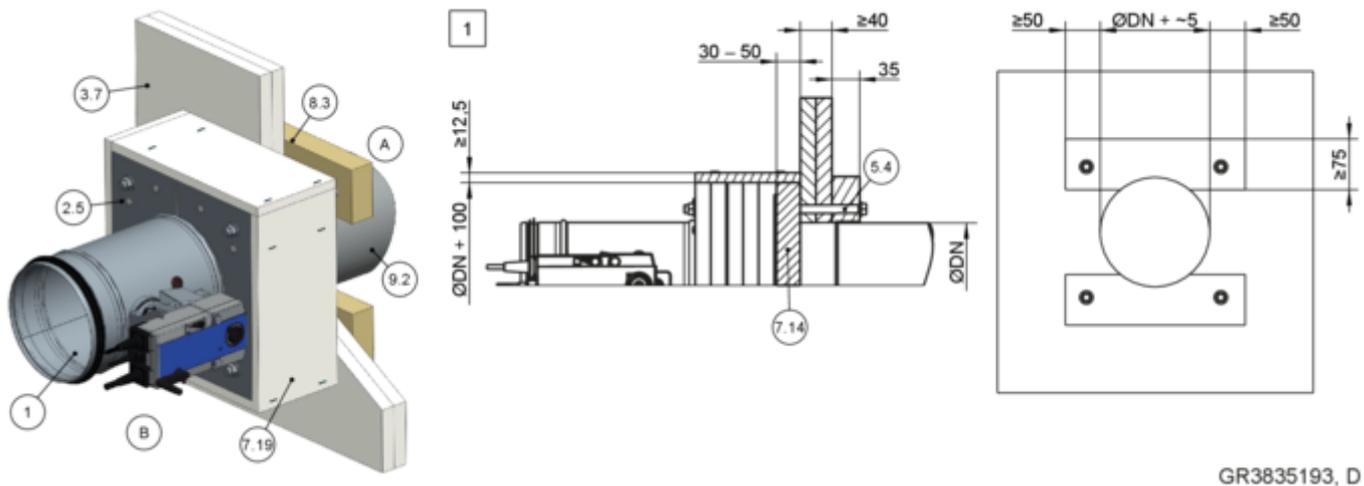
Trockeneinbau an Schachtwand mit Metallständer mit Einbausatz WA2
